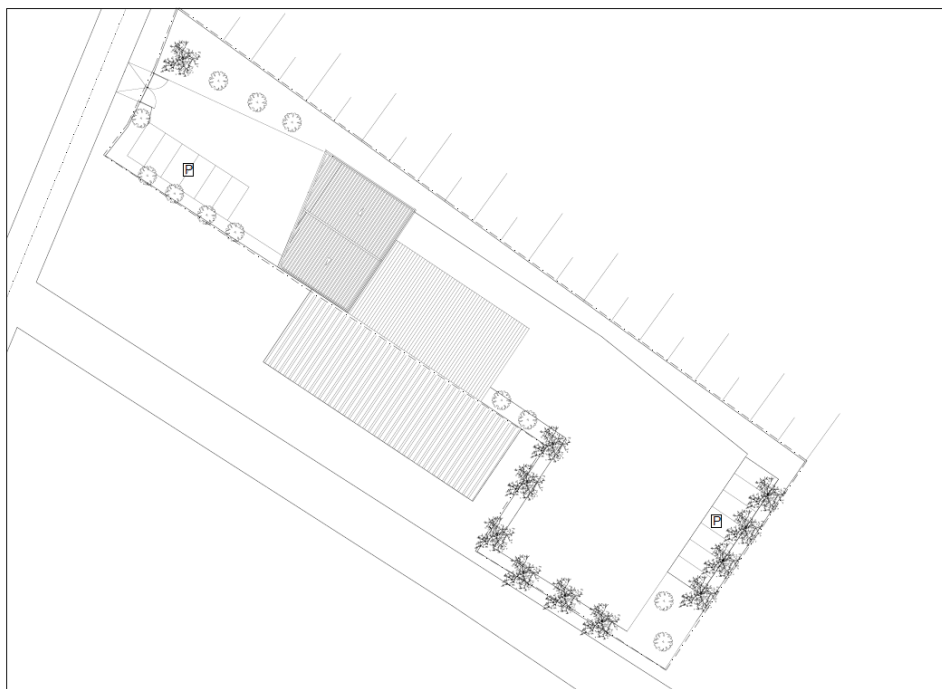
Planta de cobertura. Fonte: Ana Cândido.
